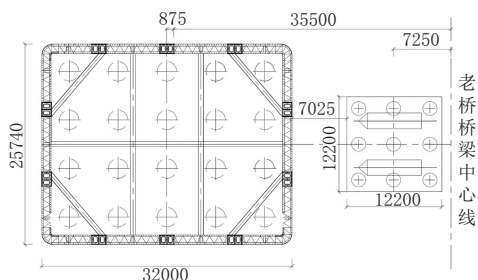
主墩双壁钢围堰与老桥位置关系平面图(单位:mm)
